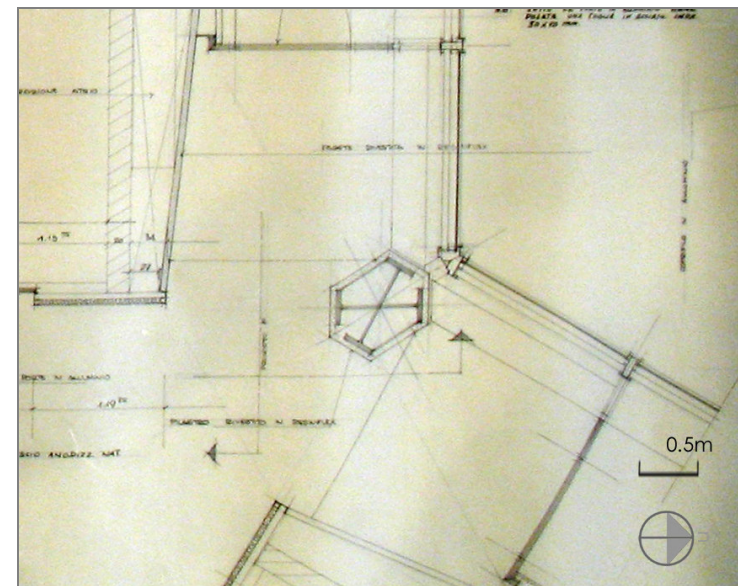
particolare pilastro d'angolo nell'intersezione dei corpi B e C (fonte CSAC – stralcio tav. 34, archivio n. 234-1)
